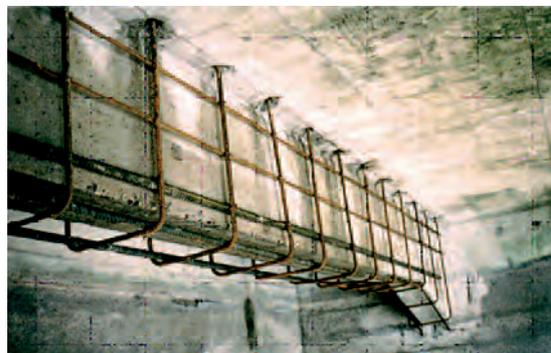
renforcement d'une poutre par ajout de béton et d'armatures (crédit photo Freyssinet)
